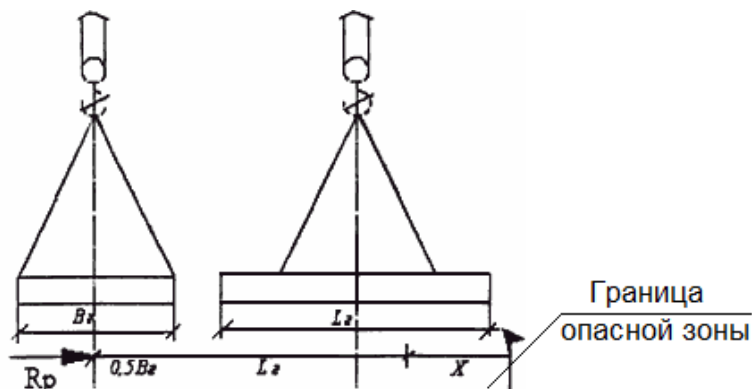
Определение границы опасной зоны при перемещении грузов кранами
